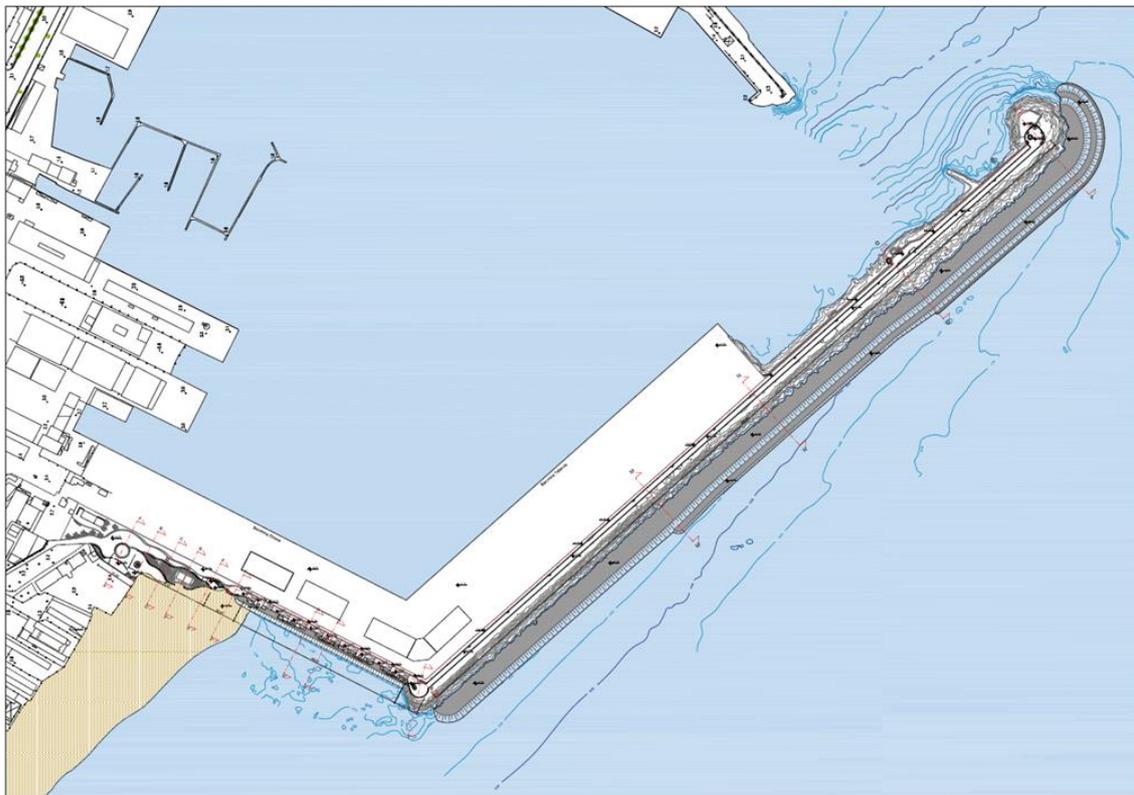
Planimetria delle opere previste nell’Ambito 4 (fonte: Elaborato E.01 – Ambito 4: “Planimetria Generale di progetto”)
